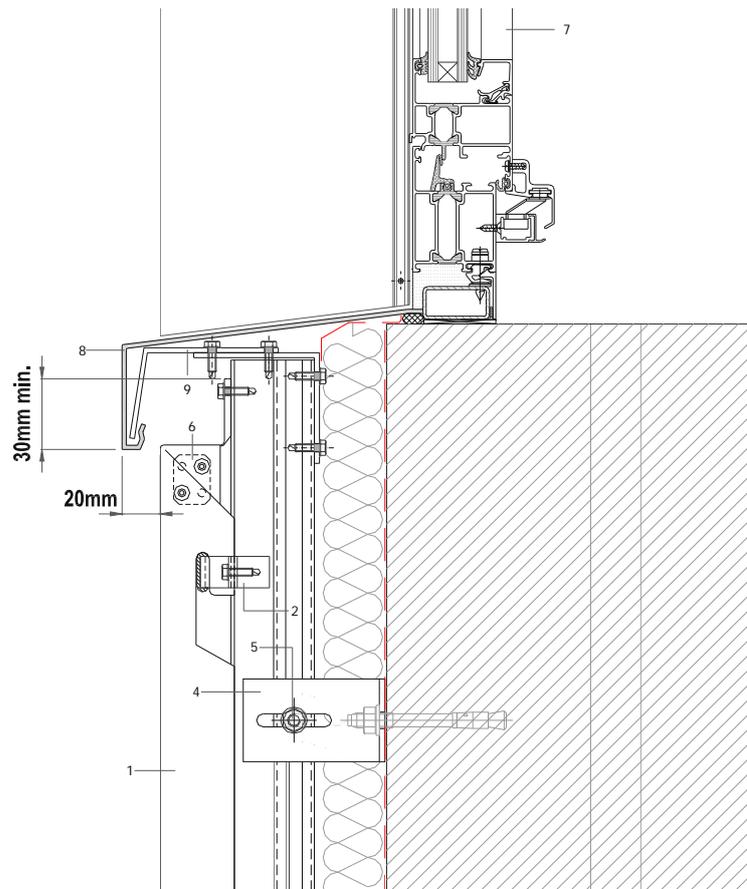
Appui de baie – Coupe verticale - Mise en œuvre avec profilé LC-2
